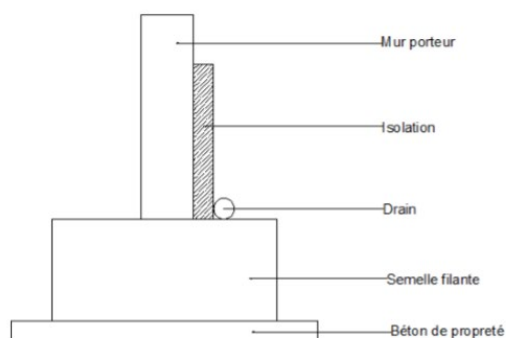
Schéma d'une fondation en semelle filante. Source : <http://www.guidebeton.com/fondations-superficielles>
